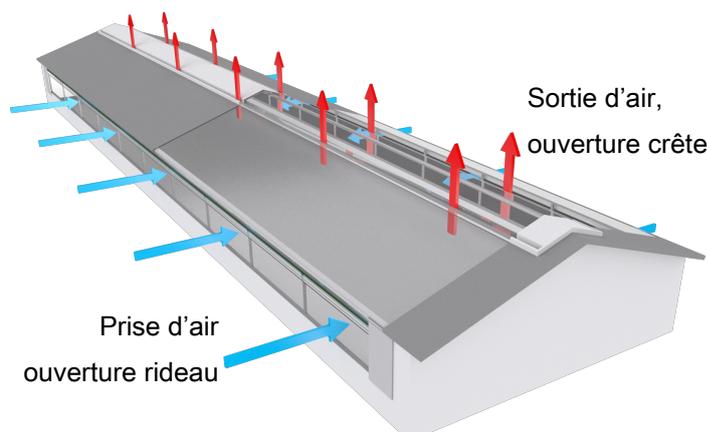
Par exemple, dans un bâtiment à la ventilation naturelle pure avec des ouvertures rideaux sur les côtés du bâtiment et une ouverture crête sur le toit.
